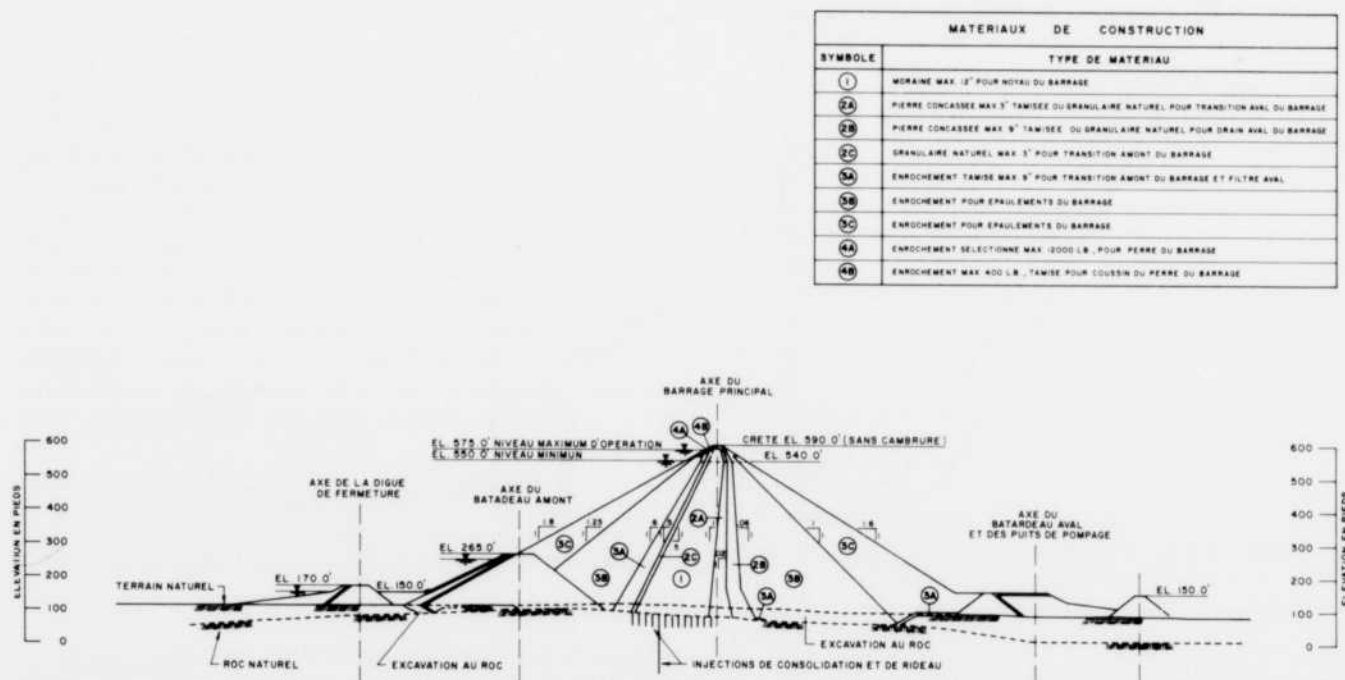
Site LG 2 - Coupe transversale du barrage principal
